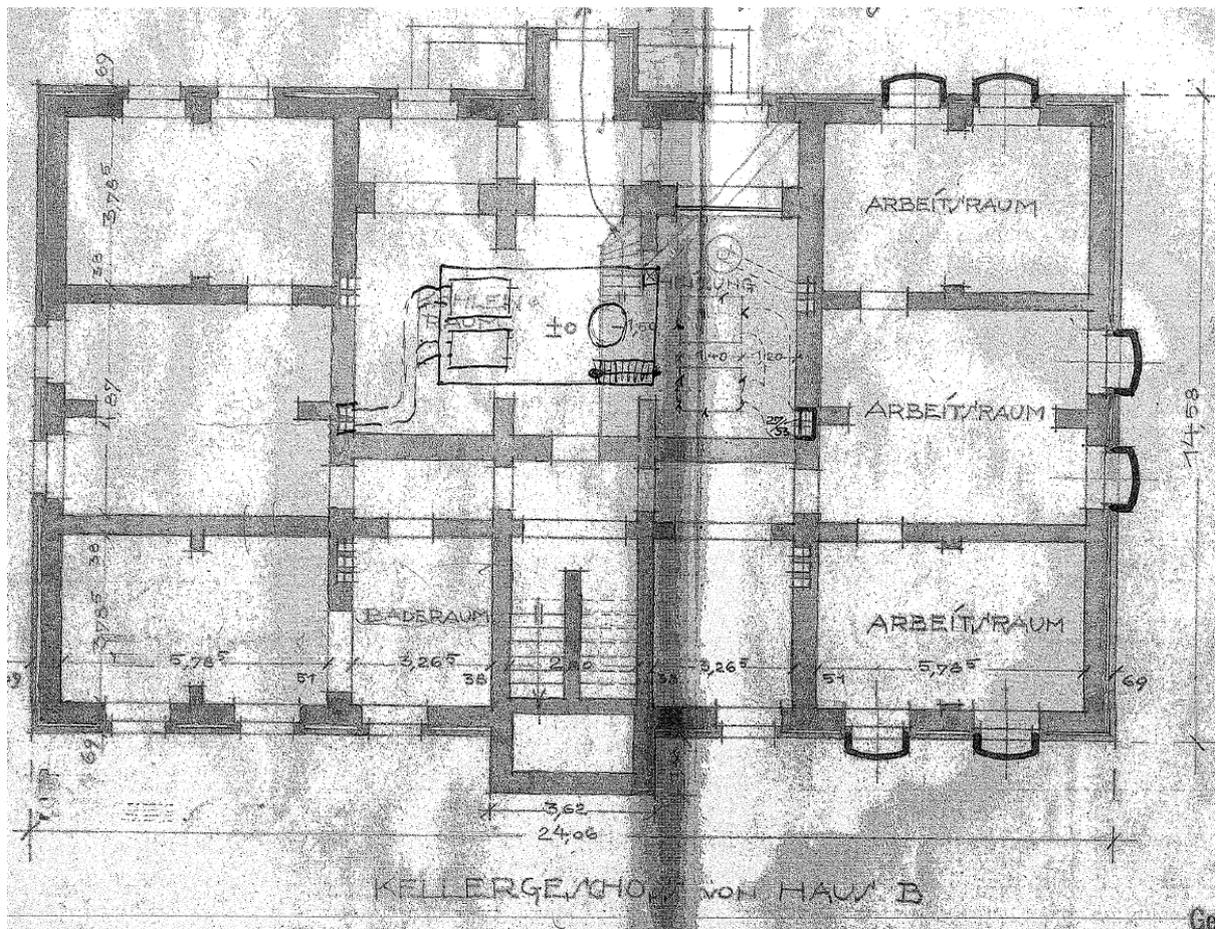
Grundriss Kellergeschoss Haus B<sup>71</sup>
